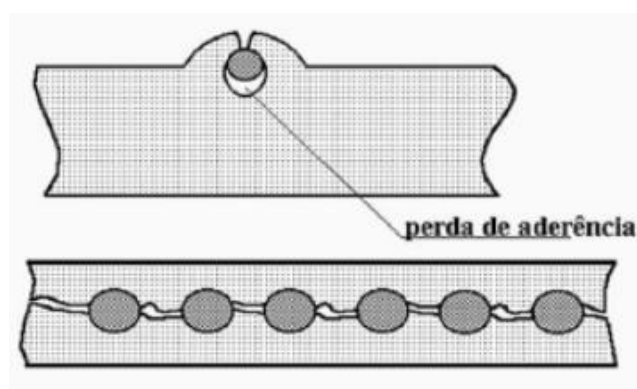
FISSURAÇÕES EM FUNÇÃO DO TIPO DE SOLICITAÇÃO PREDOMINANTE
